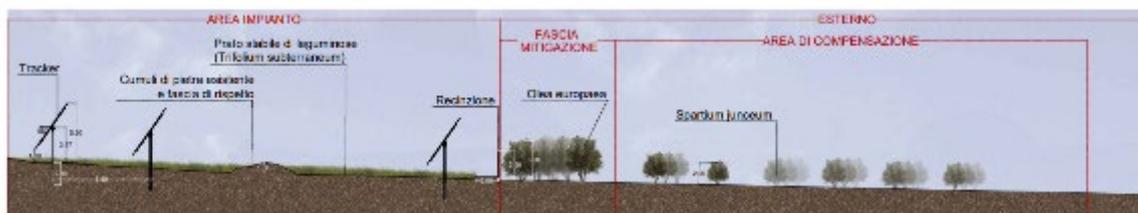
Schema tipo dell'area di compensazione MINEO-PDT11.
